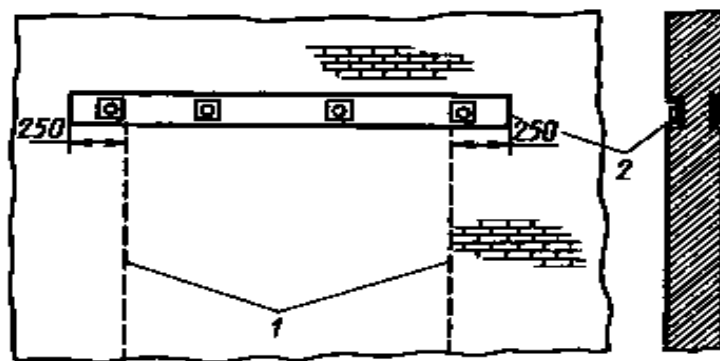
Схема закладки стальных балок перемычки при пробивке проема в стене:
